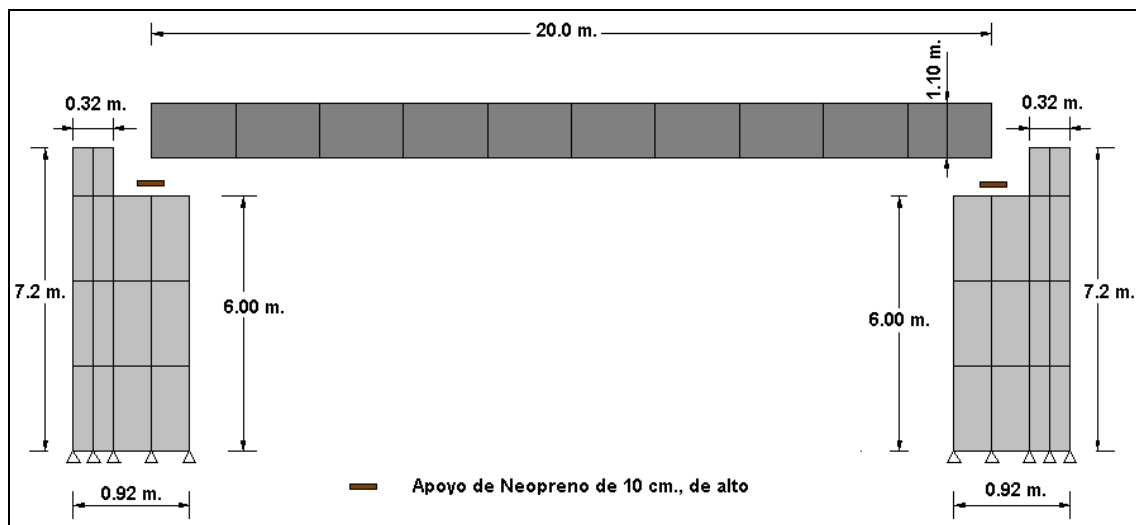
Puente conformado por dos estribos y vigas longitudinales.
